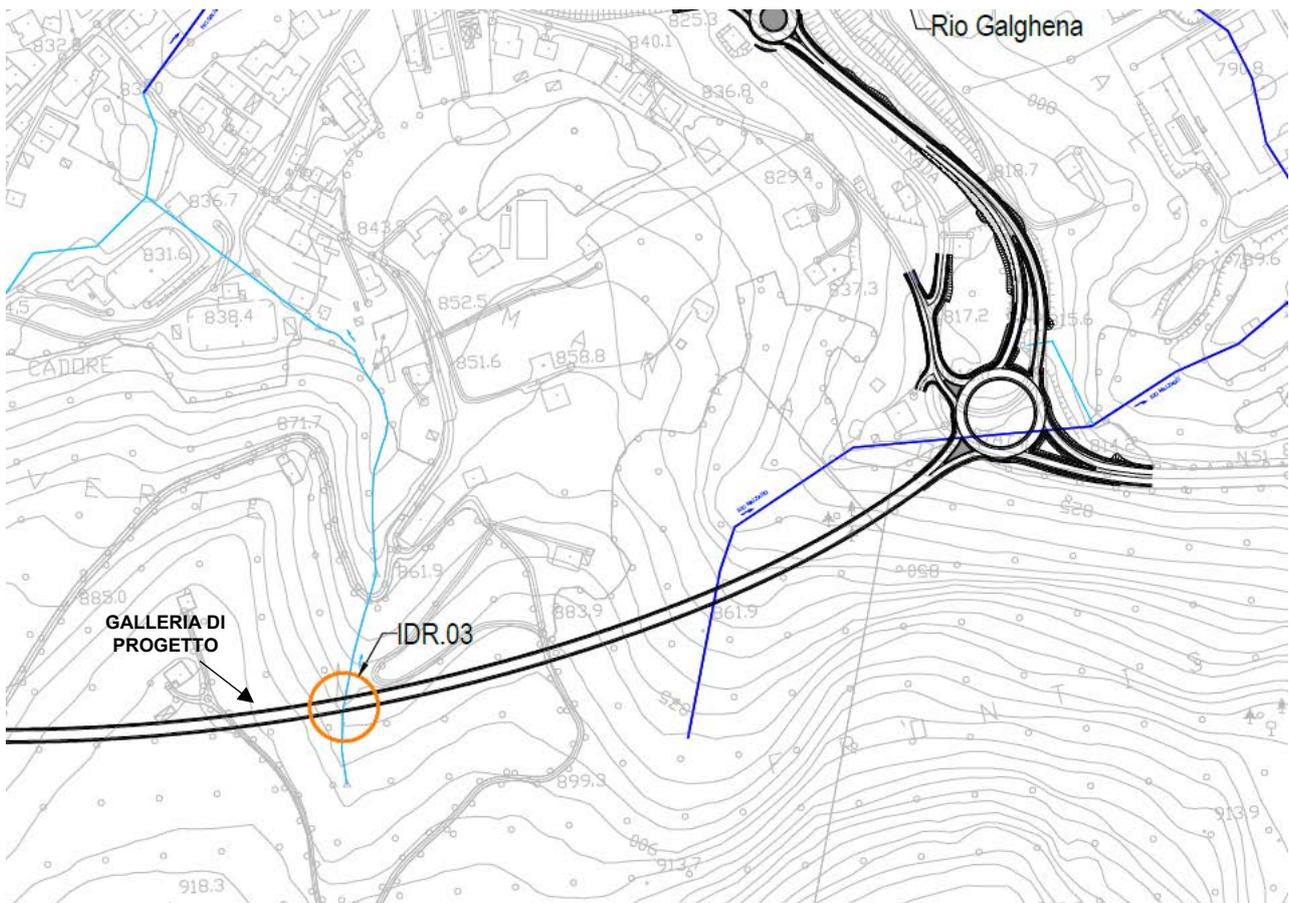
Planimetria di progetto relativa alle interferenze idrauliche - Particolare interferenza IDR.03
